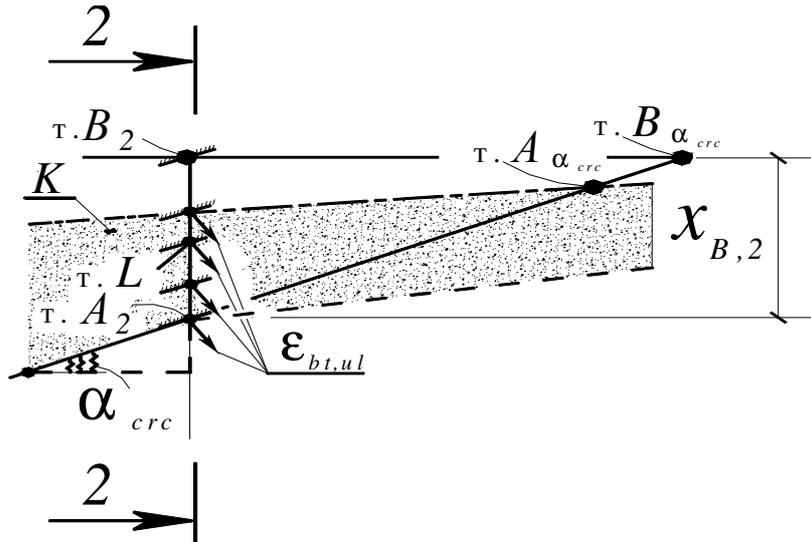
Предельные деформации удлинения бетона на главных площадках в сечении 2–2 над наклонной трещиной третьего типа
